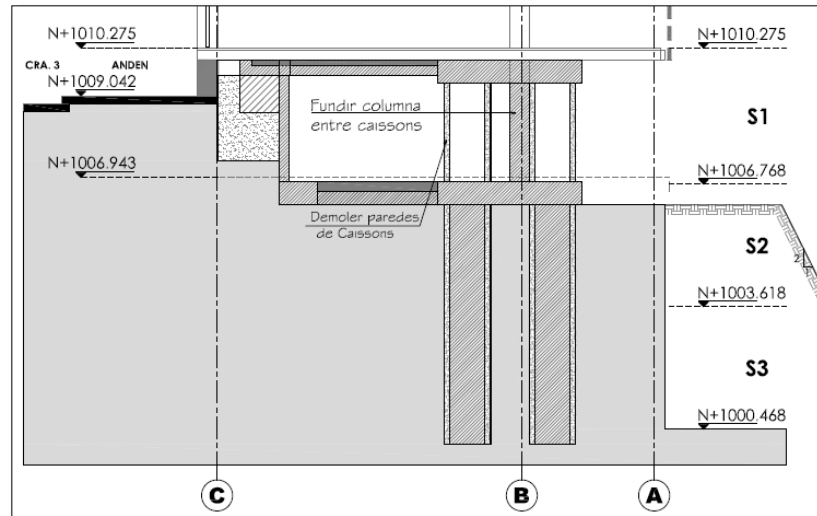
Sección Paso 5 Alternativa 4 – Fundición de columna en sótano.
